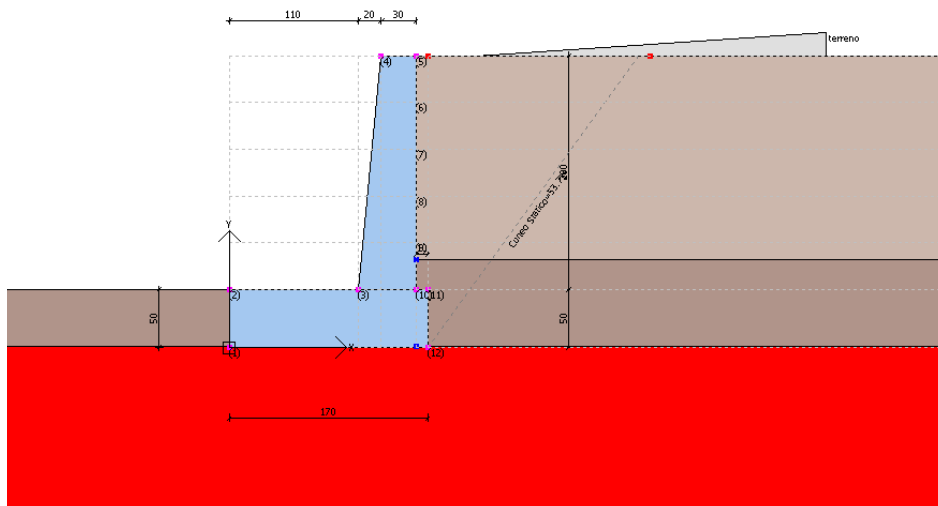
Geometria del muro M01 – Concio 11 – Sezione di verifica
